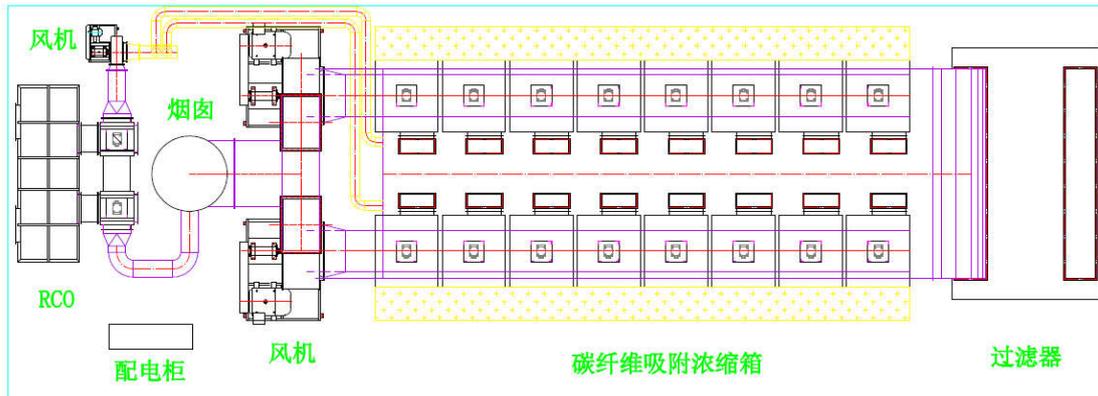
活性炭纤维吸附-脱附-催化燃烧装置平面布置图
